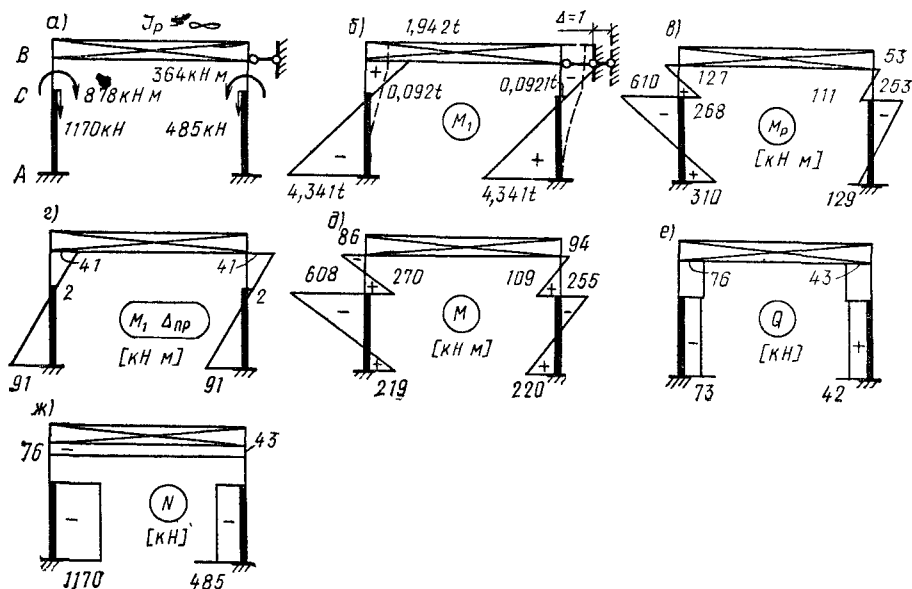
К расчету рамы на вертикальную нагрузку от мостовых кранов
